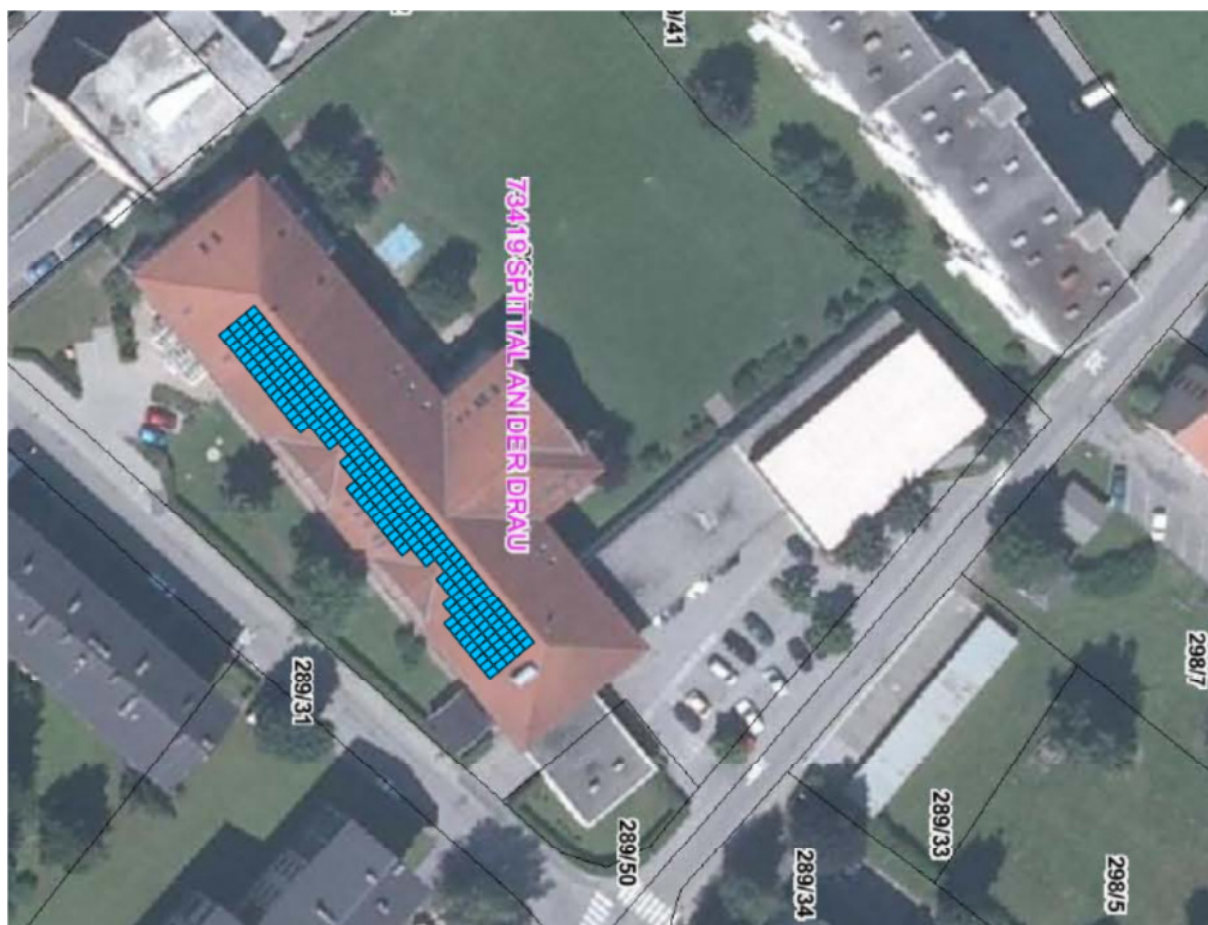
PV-Anlage Schulzentrum Ost, Lageplan (Quelle: Techn. Beschreibung EPG, 16.12.2011)
